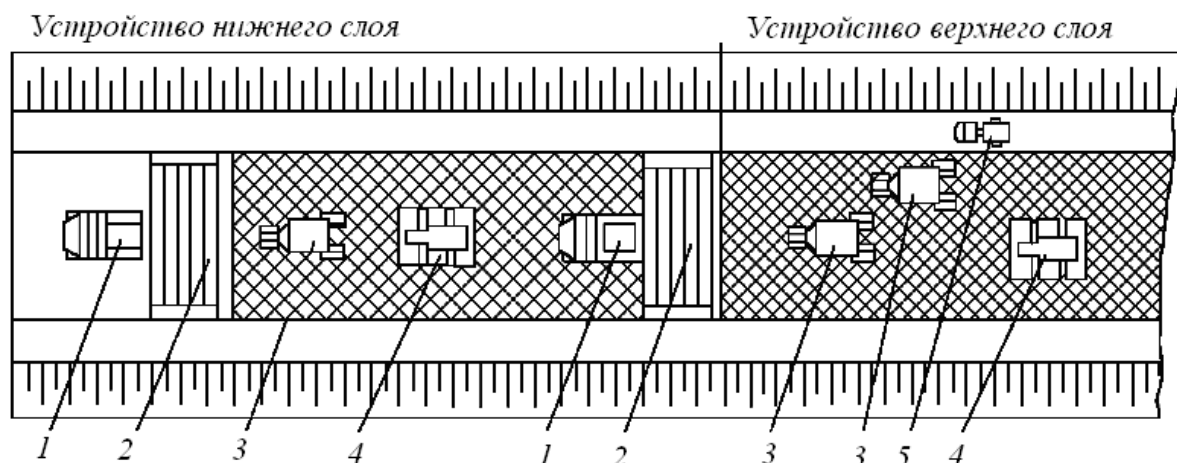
Технологическая схема устройства двухслойного асфальтобетонного покрытия на проектную ширину при работе в одну смену:
